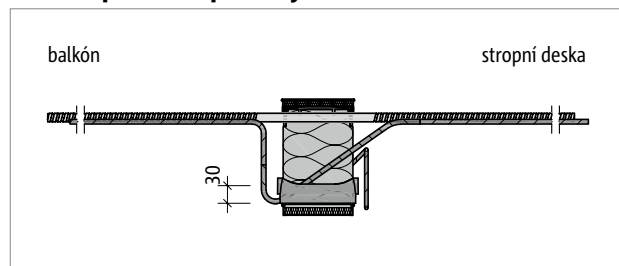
Schöck Isokorb® CXT typ KL-M4-V1: Řez prvkem
